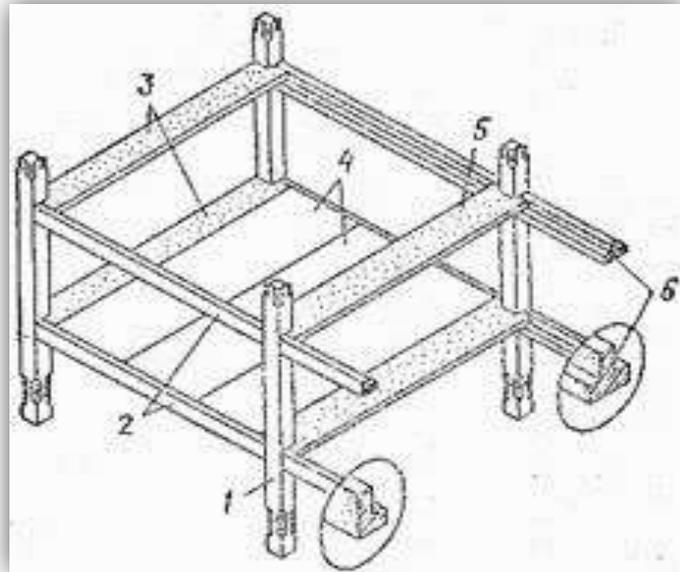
Конструктивные элементы сборного железобетонного каркаса гражданского здания
